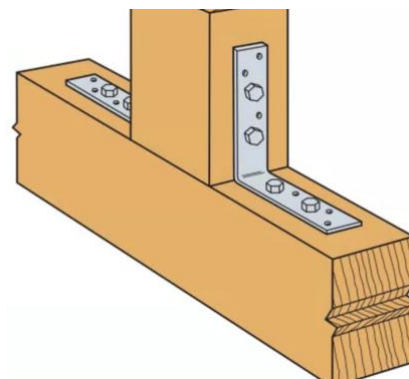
Angulo de refuerzo galvanizado Ref. (Angulo de refuerzo 6"*6", 2023)
